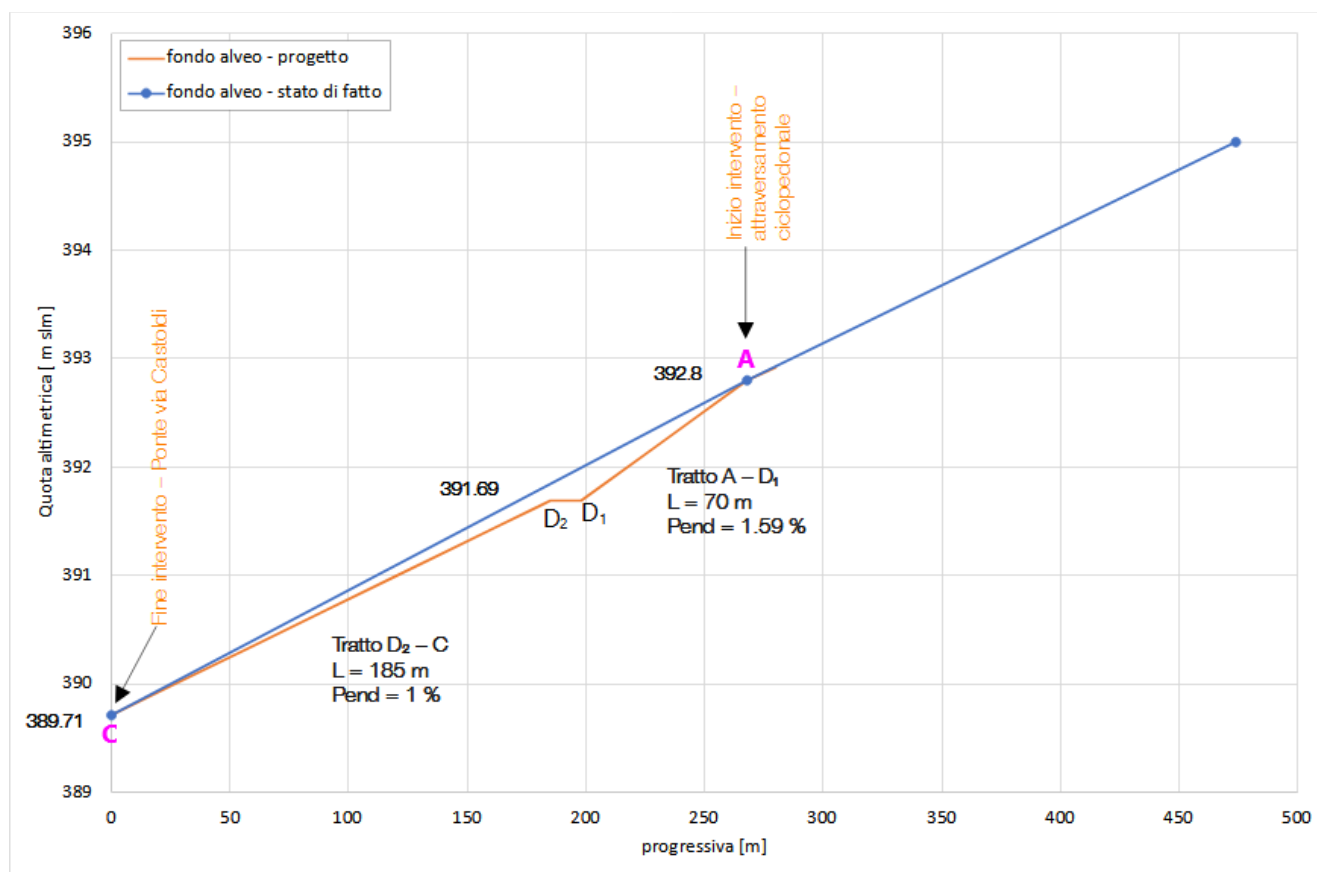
Profilo longitudinale del T. Vellone all'interno dell'area di progetto – Stato di progetto (v. anche K-plan in figura 7)
